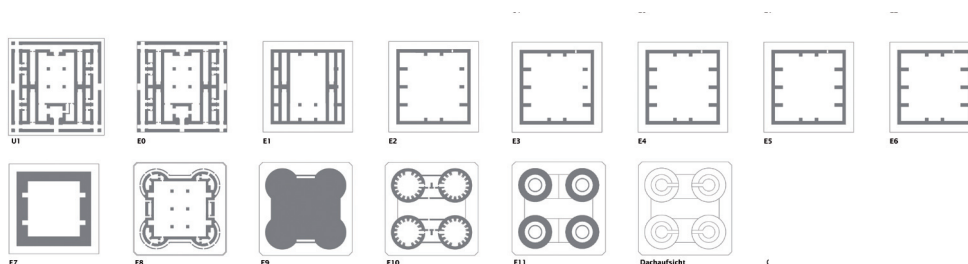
Vielschichtig: Grundrisse + Dachaufsicht des ehemaligen Flakbunkers vor dem Umbau
